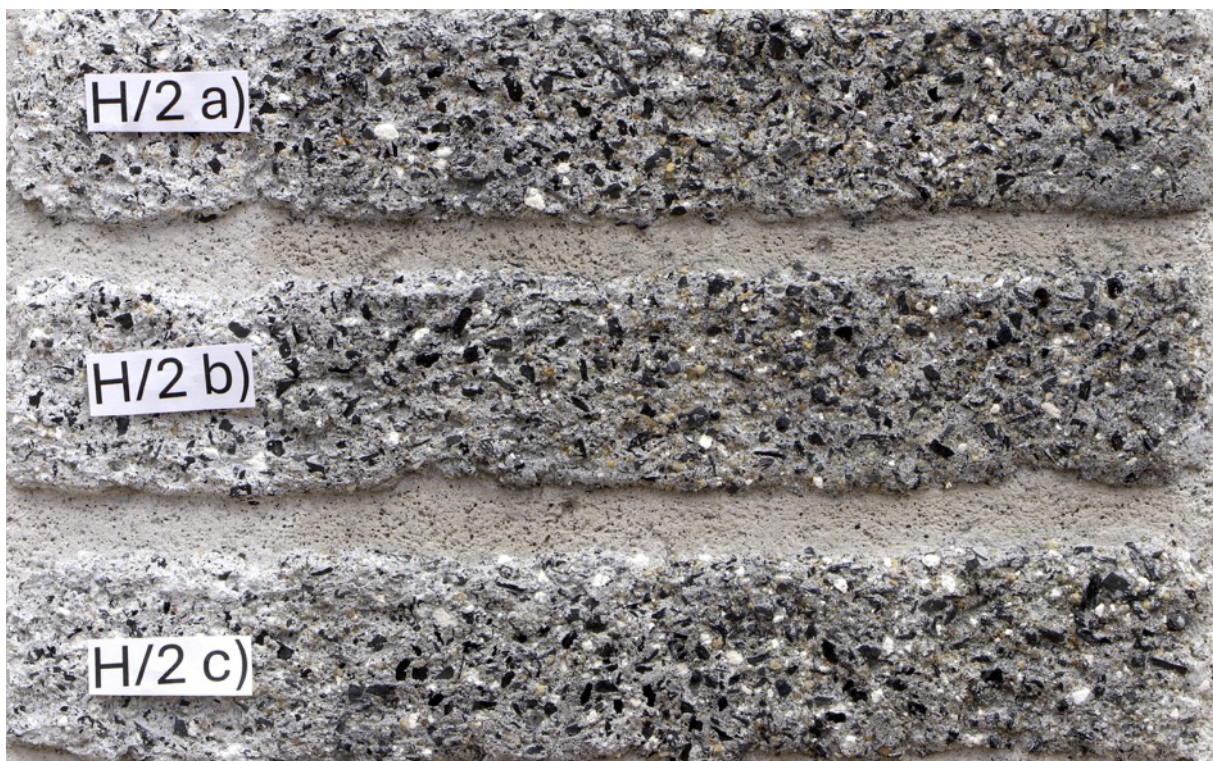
Detail panelu 2, skupina 1 (1:3).
